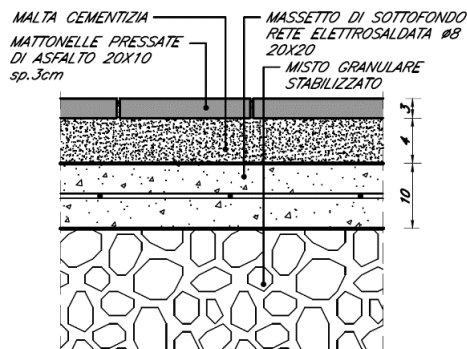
Dettaglio pacchetto H14 e schema di posa
